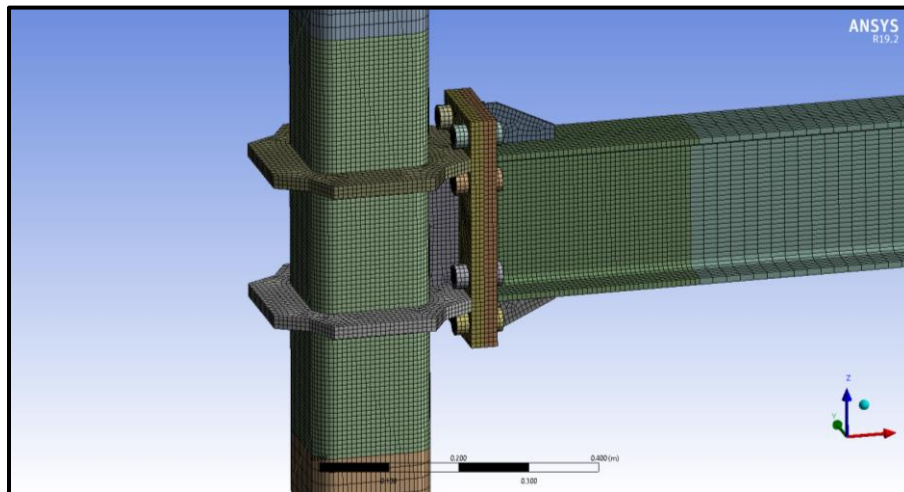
Conexión Tipo I con diafragmas externos y columnas cuadradas.
